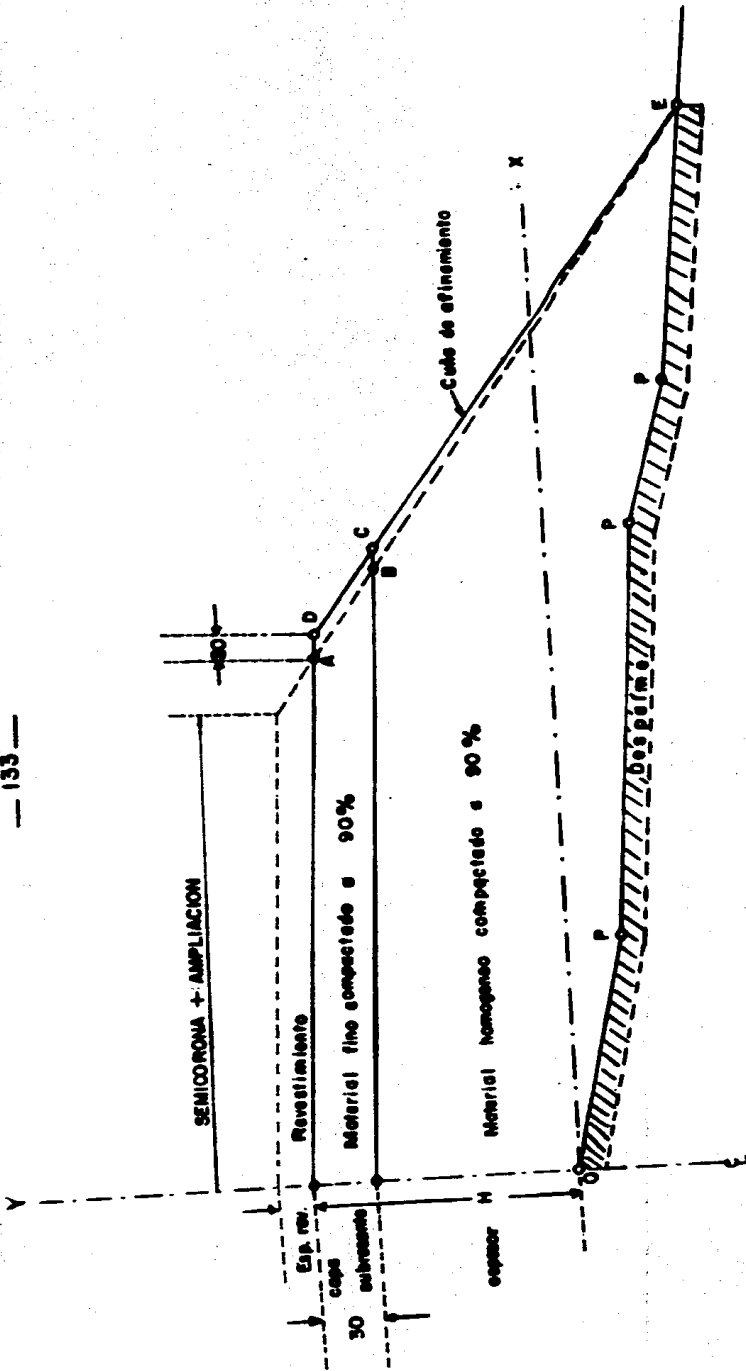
SECCION TIPO I ( EN TERRAPLEN )
